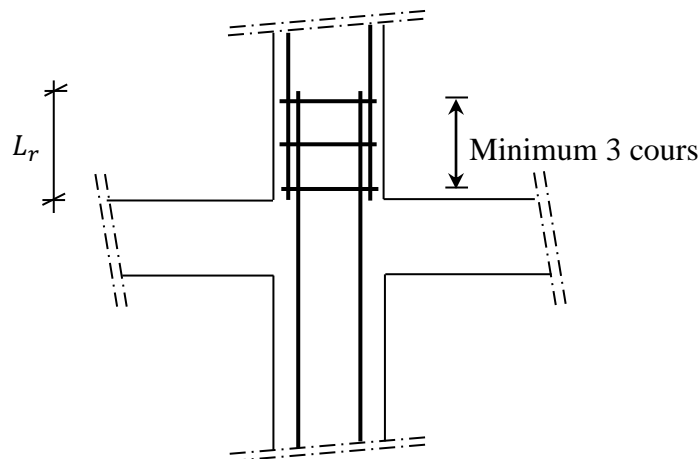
Les armatures transversales dans la zone de recouvrement
